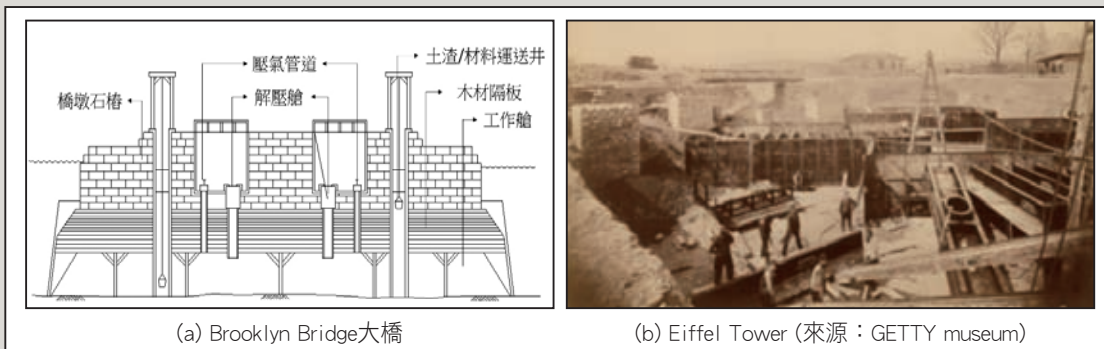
紐約Brooklyn Bridge大橋及巴黎艾菲爾鐵塔之基礎採壓氣沉箱施工
